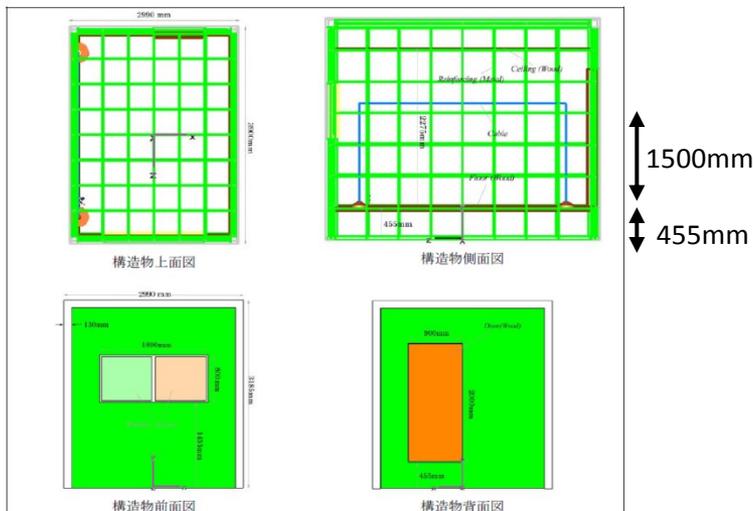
計算モデルの構造 (鉄筋コンクリート構造物)
